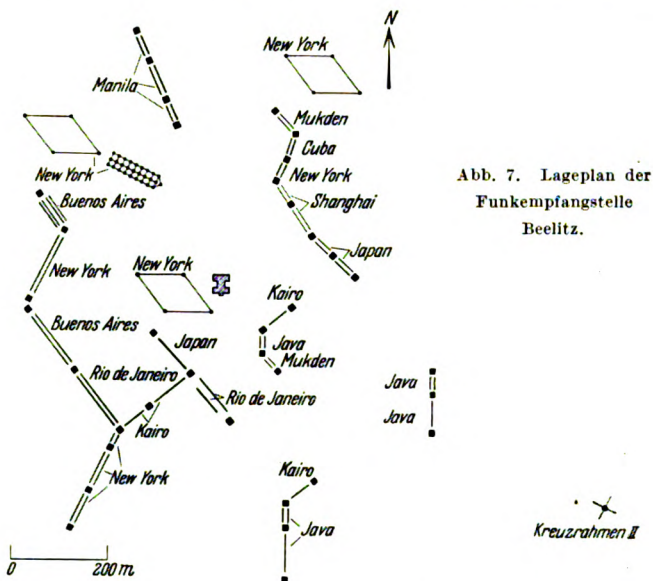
Lageplan der Funkempfangsstelle Beelitz.
